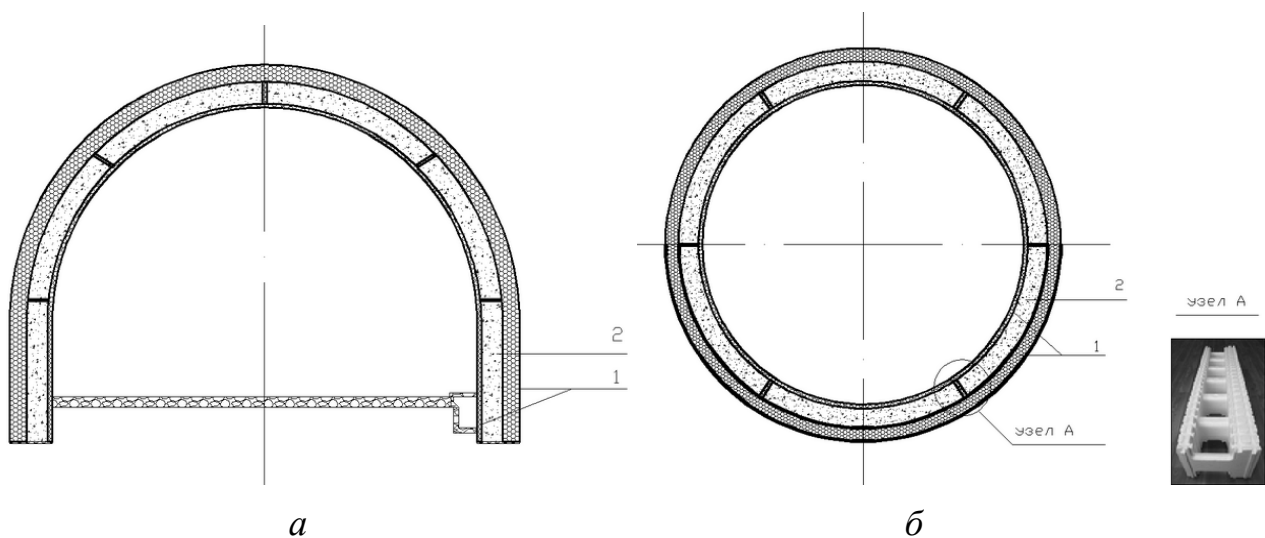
Конструкція тришарового бетонного кріплення де тимчасове кріплення є одразу і незнімною опалубкою і податливим шаром:
